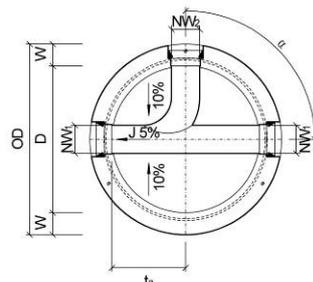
Grundriss CRENO Normschachtboden Typ 8
